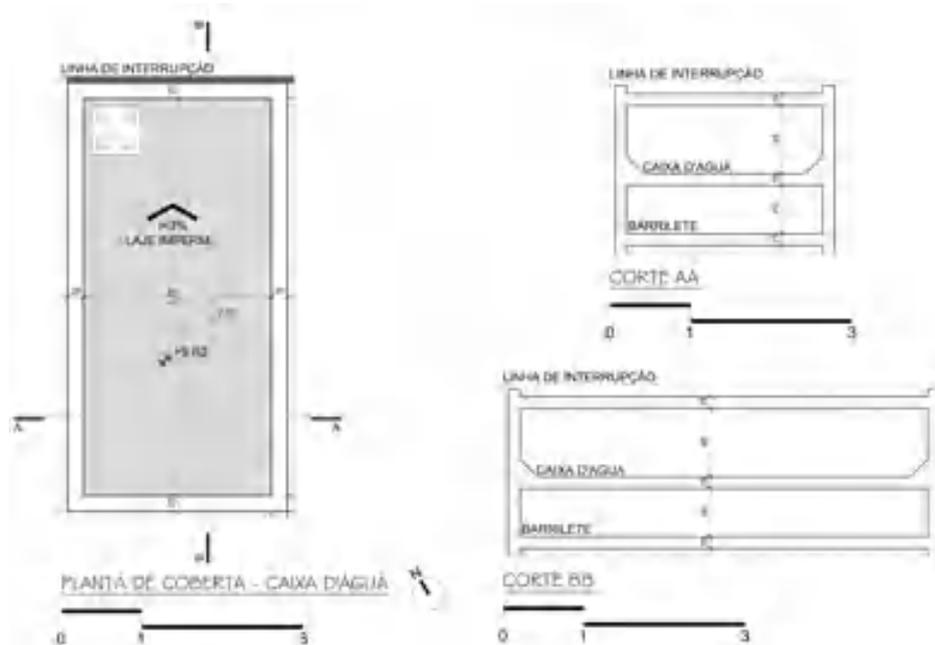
Planta de cobertura e cortes da caixa d'água.
